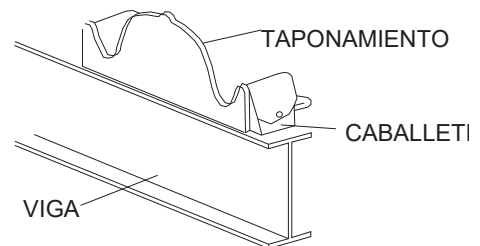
Detalle del taponamiento de la cubierta autoportante. ^{40.2}
